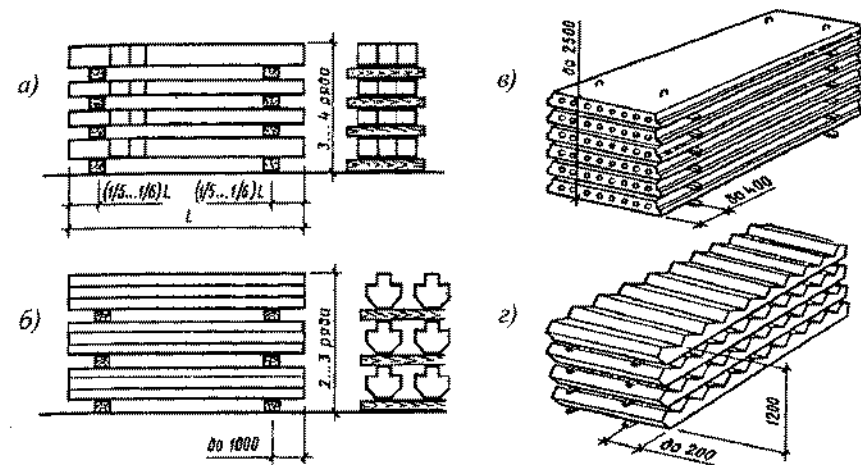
Складирование сборных конструкций для многоэтажных промышленных зданий:
